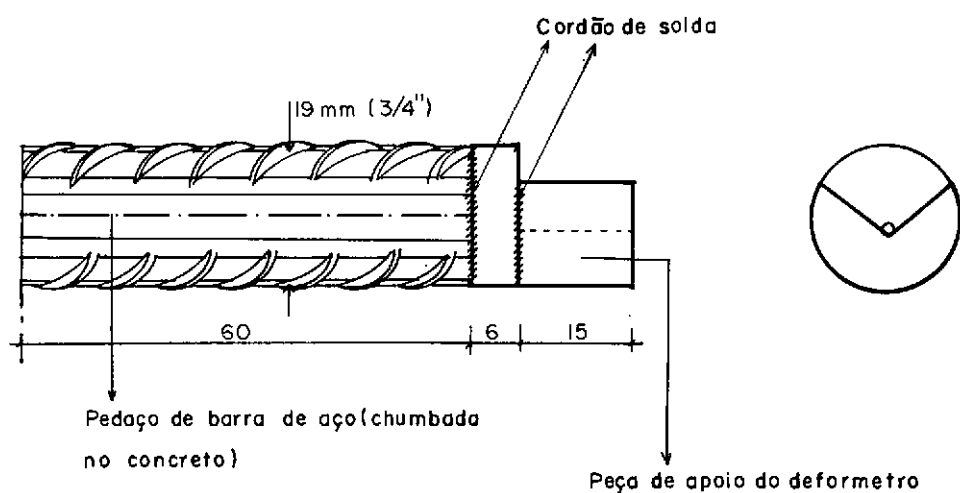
Sistema de apoio para leituras no concreto: pedaco de barra de aço soldada à peça de apoio do deformetro. (Cotas em mm)
